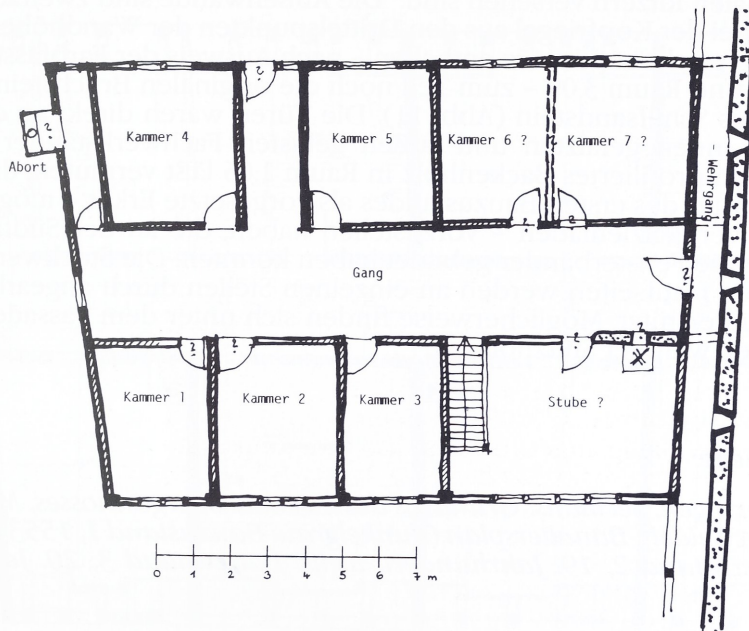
Öhringen, Seelhaus. Rekonstruktionsskizze des ersten Bauzustandes (1553 ff.), Grundriß des ersten Obergeschosses, M 1:200.
